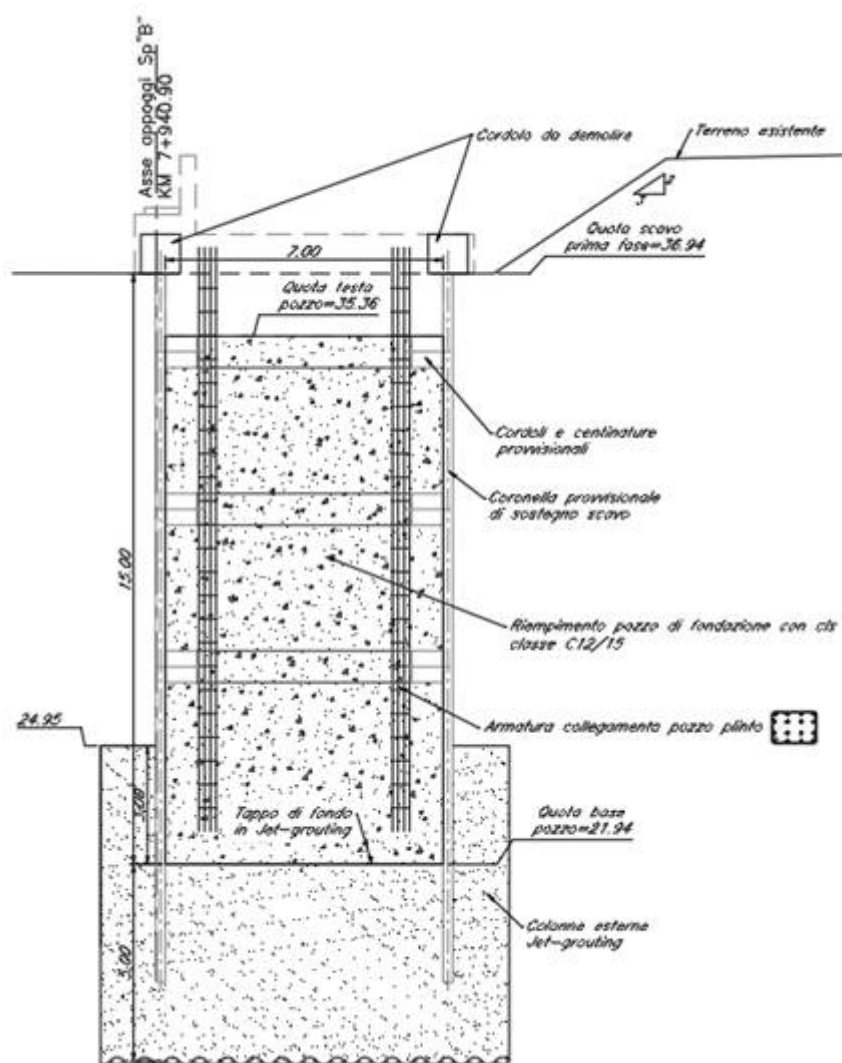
Sezione longitudinale trattamento con jetgrouting
